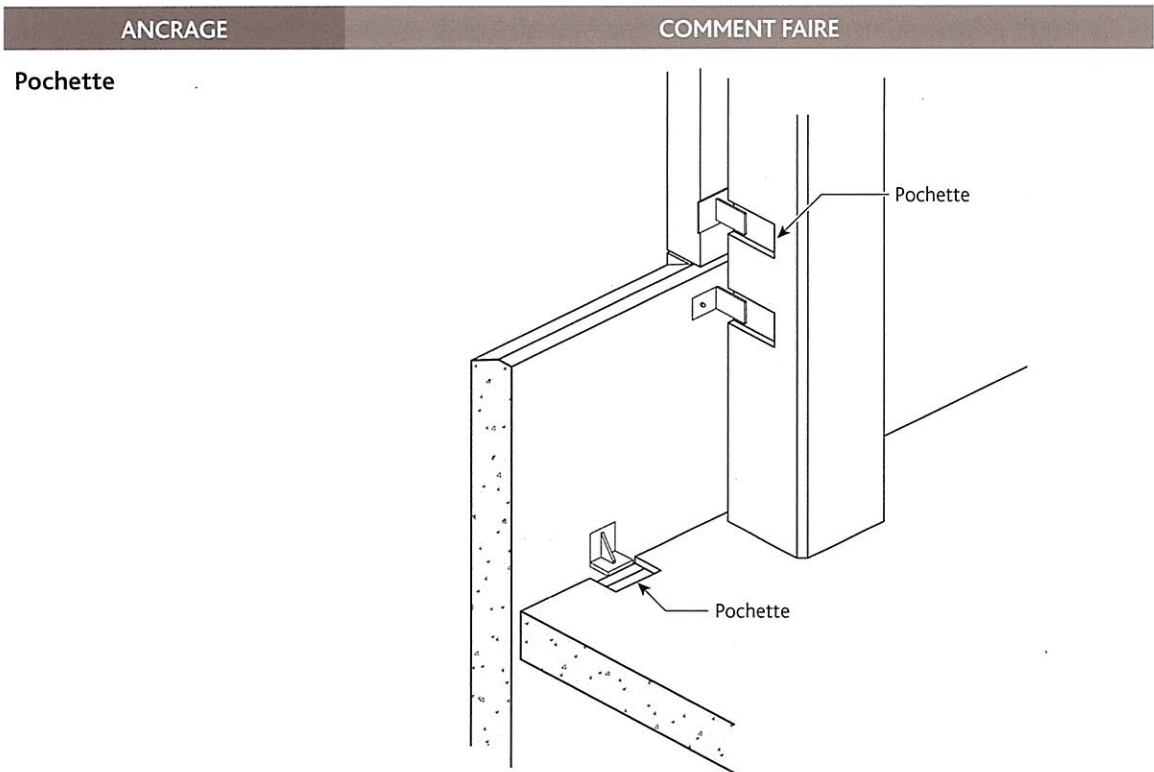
Ancrages et joint pour éléments préfabriqués de béton (suite)
